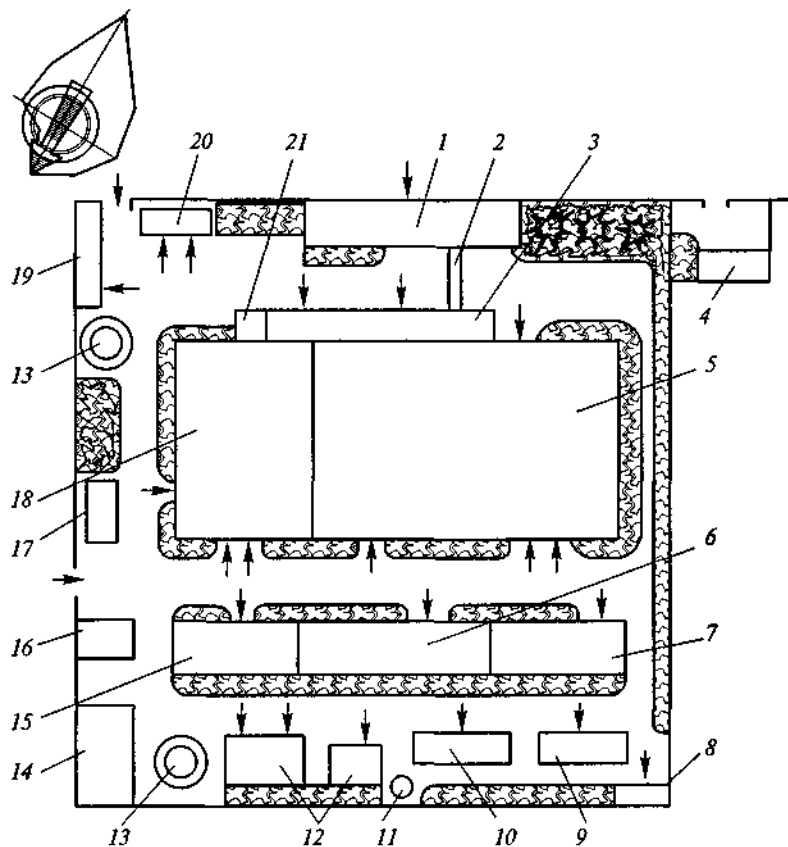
Генеральный план ткацкой фабрики и роза ветров:
